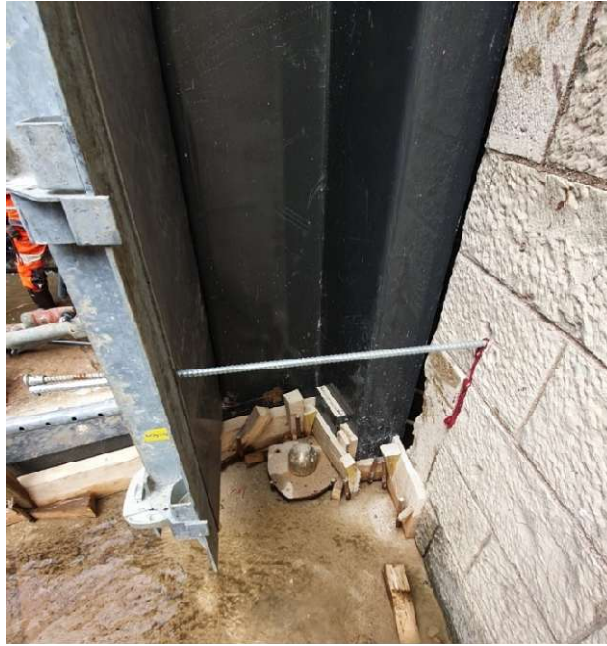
Pivot crapaudine – écluse des Boisseaux (Source - LM INGENIERIE)
